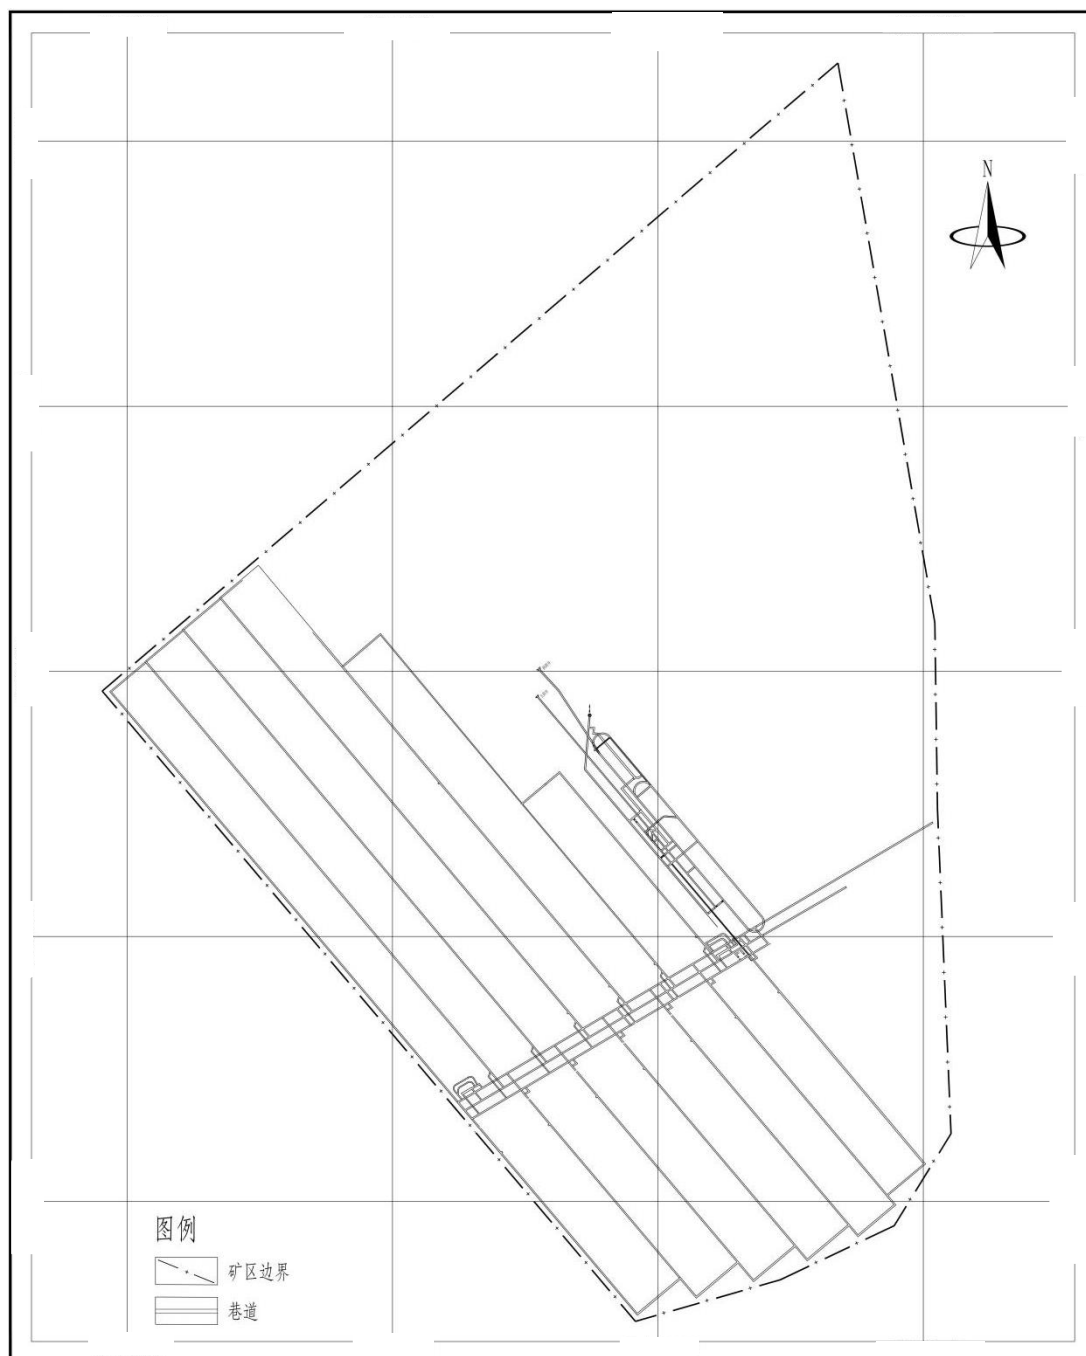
煤层开拓大巷平面布置图（二水平）
